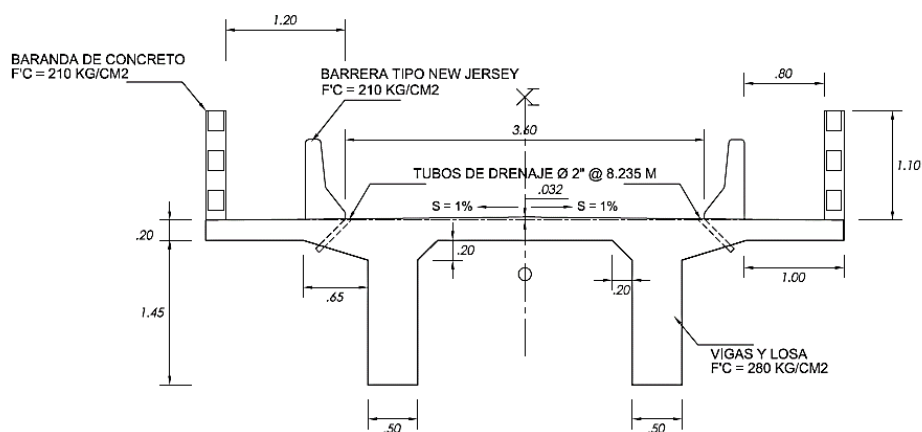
Sección transversal Puente la Capilla.(P-1 Anexo4)
